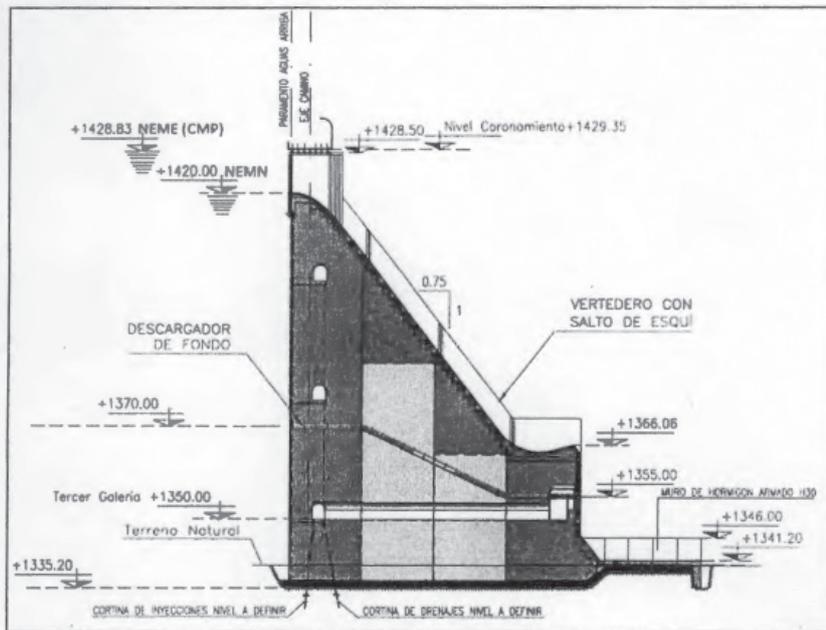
Perfil Tipo de la Presa de Hormigón
